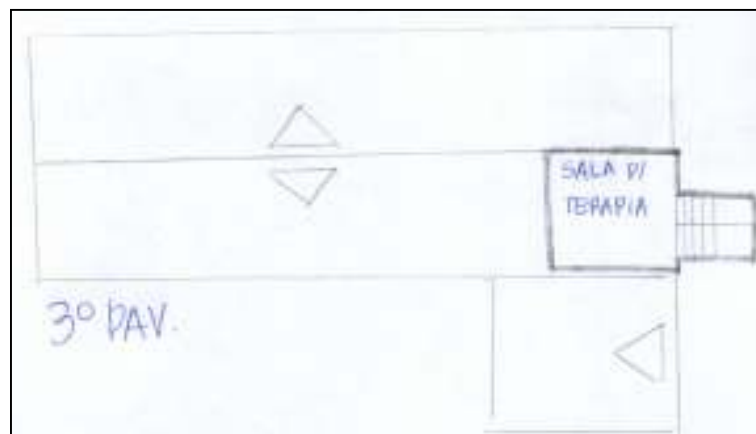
Croqui esquemático da planta baixa do 3º pavimento do Santé Spa. Fonte: autora (2011)
